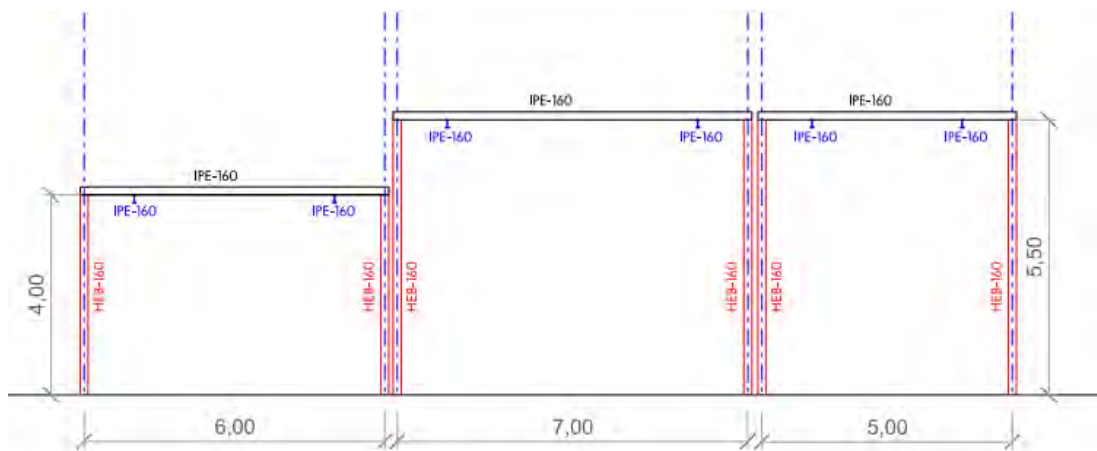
Sección de la estructura de la instalación y perfiles utilizados
